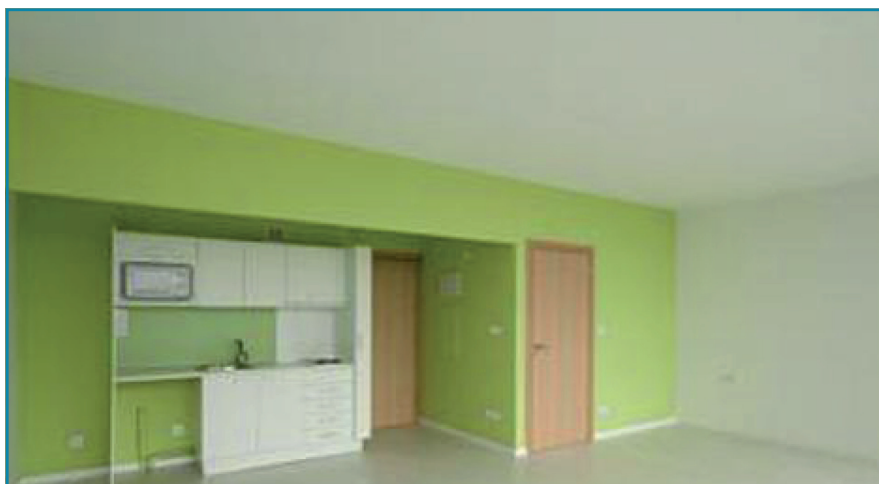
Vista interior de la vivienda. Fotografía: cortesía de Regesa.
